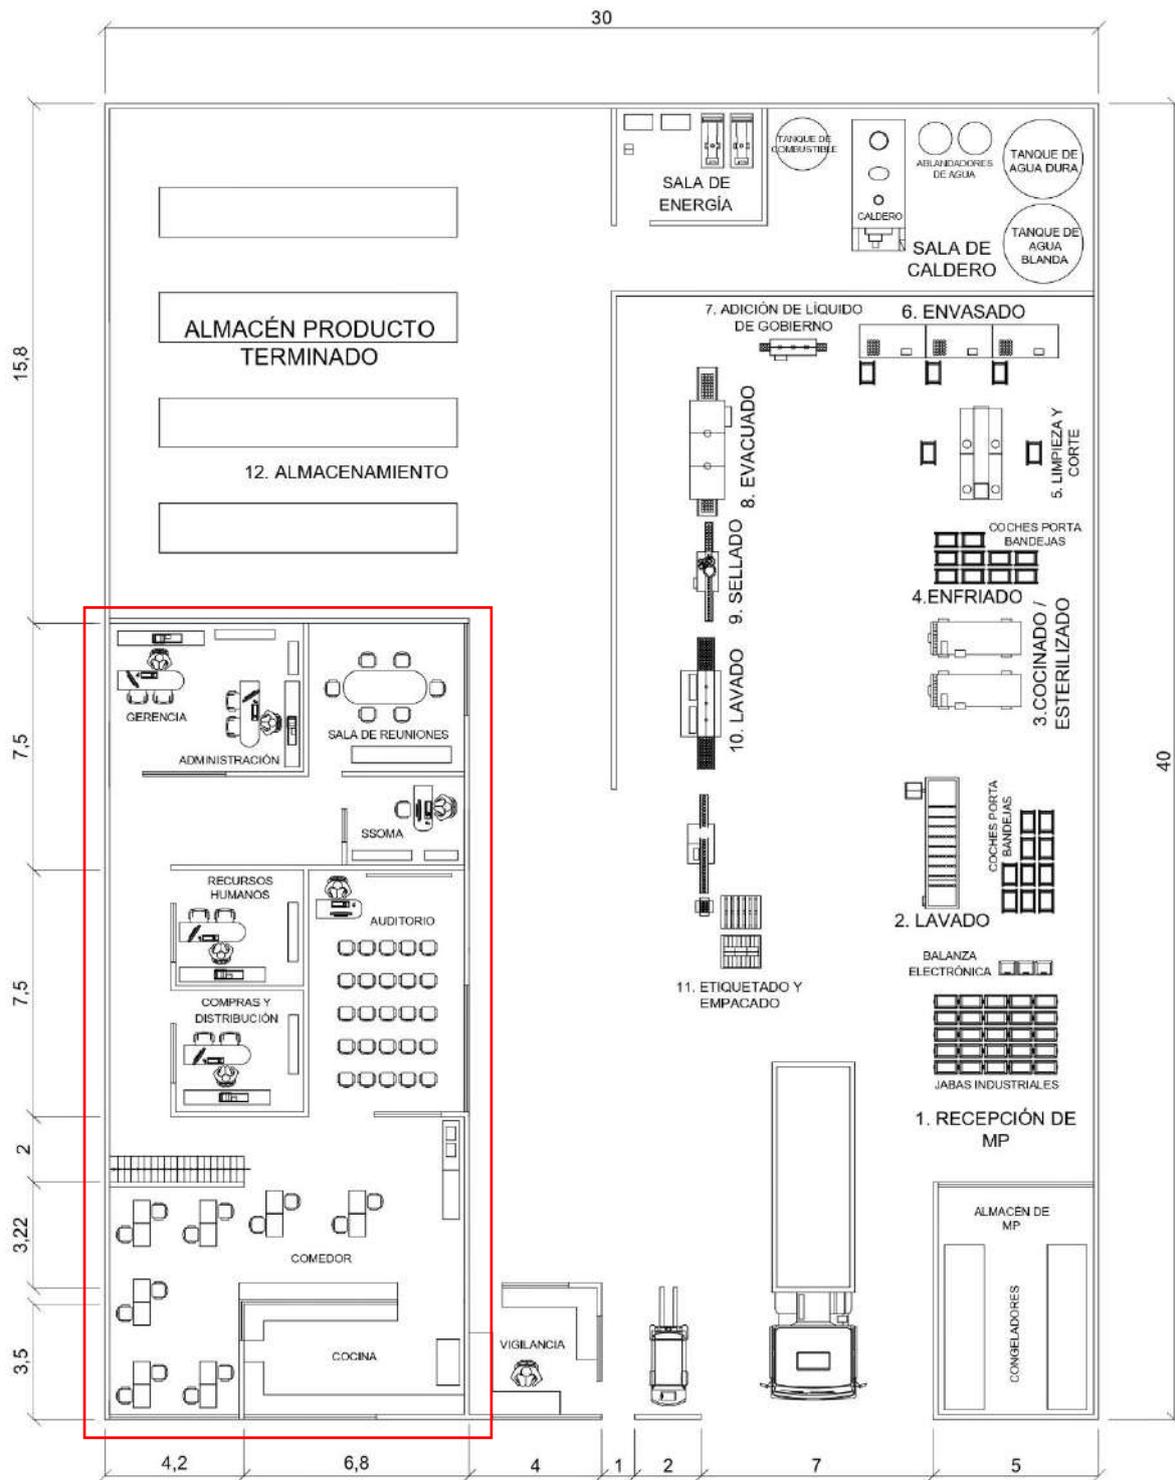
Vista de planta propuesta de la fábrica de conservas de pescado (segundo piso).
